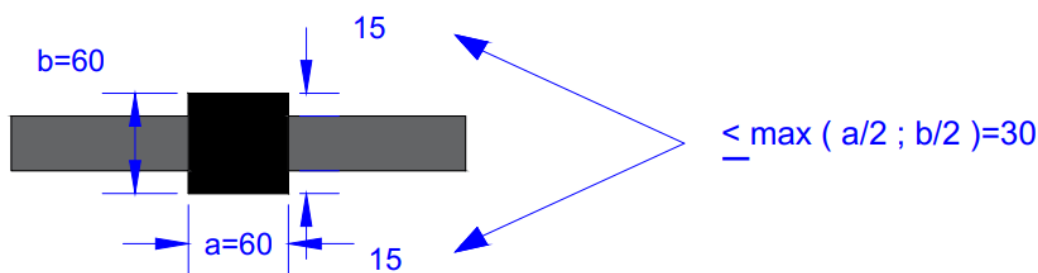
Dimensions à respecter pour les poutres et poteaux
